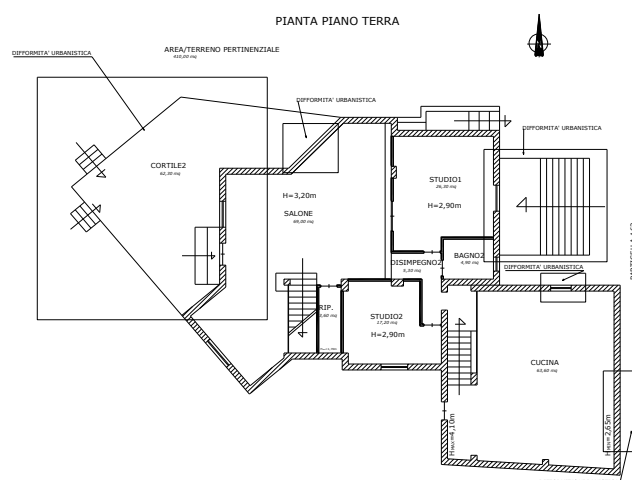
planimetria delle difformità urbanistiche del piano terra della villa
